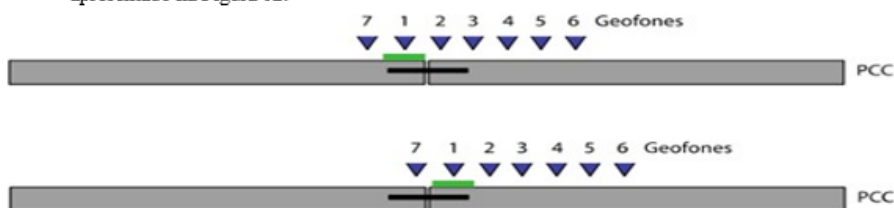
Perfil da disposição dos geofones nas juntas no levantamento com FWD
